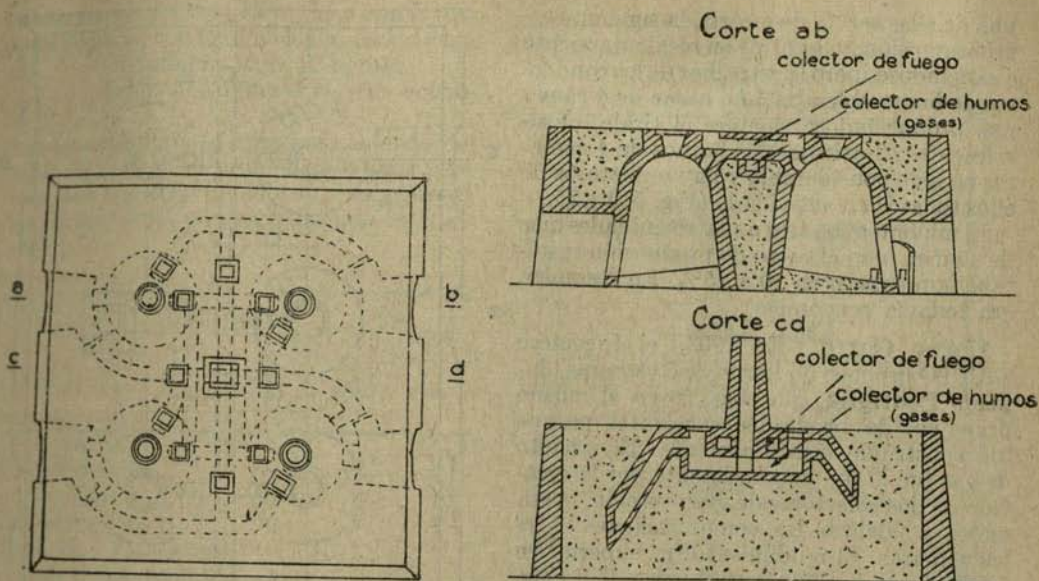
Horno Gill de 4 cámaras. Visto en planta y según los cortes ab y cd.
